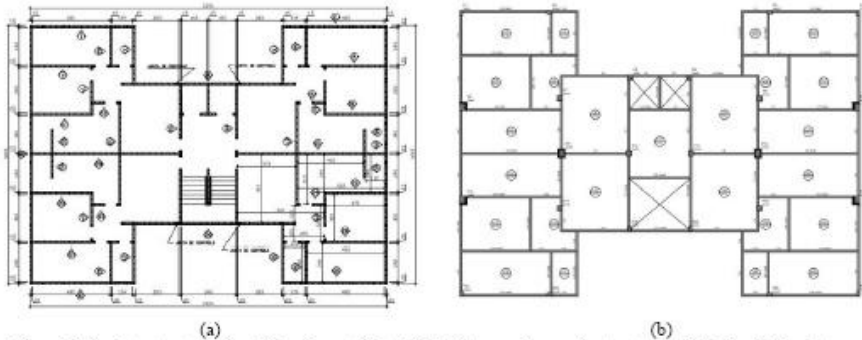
Projeto estrutural da edificação estudada: (a) Projeto em alvenaria estrutural – 1ª fiada; (b) Projeto em concreto armado.
